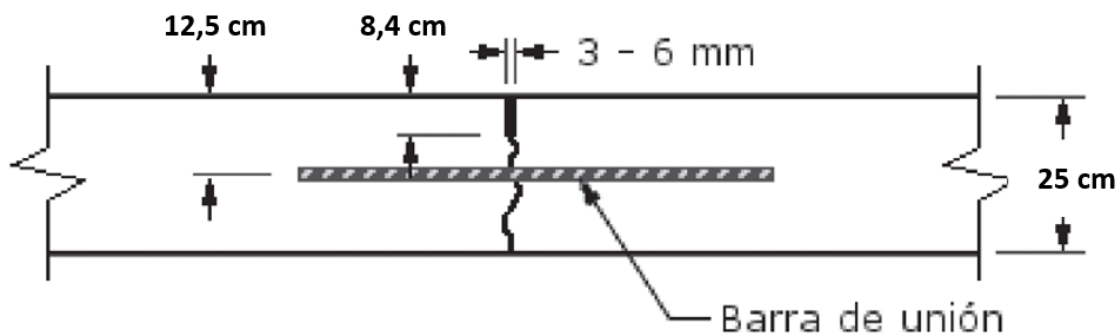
Detalle Junta transversal de dilatación. Fuente: elaboración propia.
